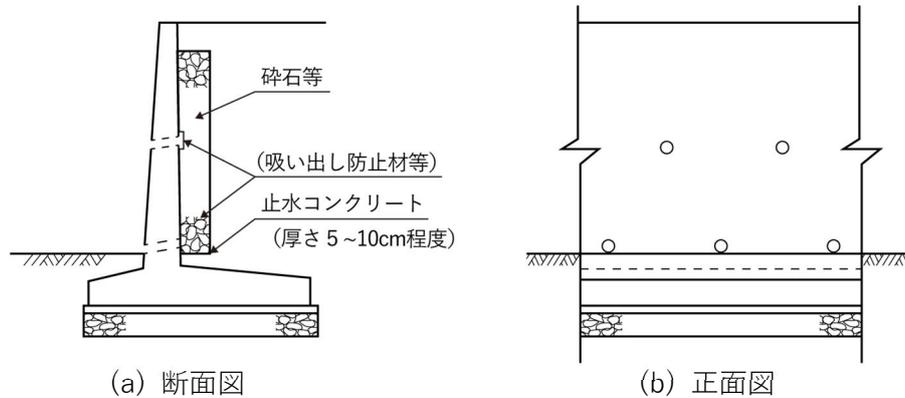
鉄筋コンクリート擁壁の断面図及び水抜穴設置図
